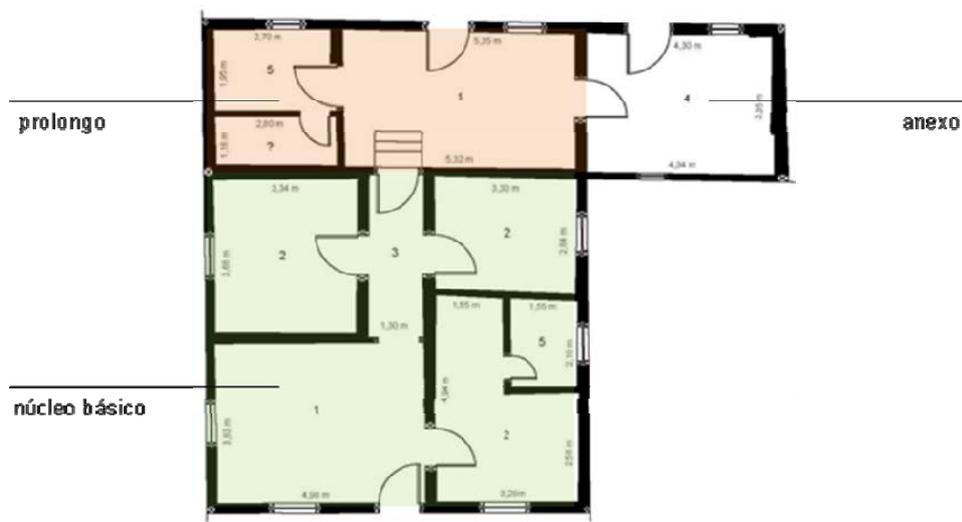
Planta baixa da morada da Fazenda Sobradinho II, destacados núcleo básico, prolongo e anexo.
